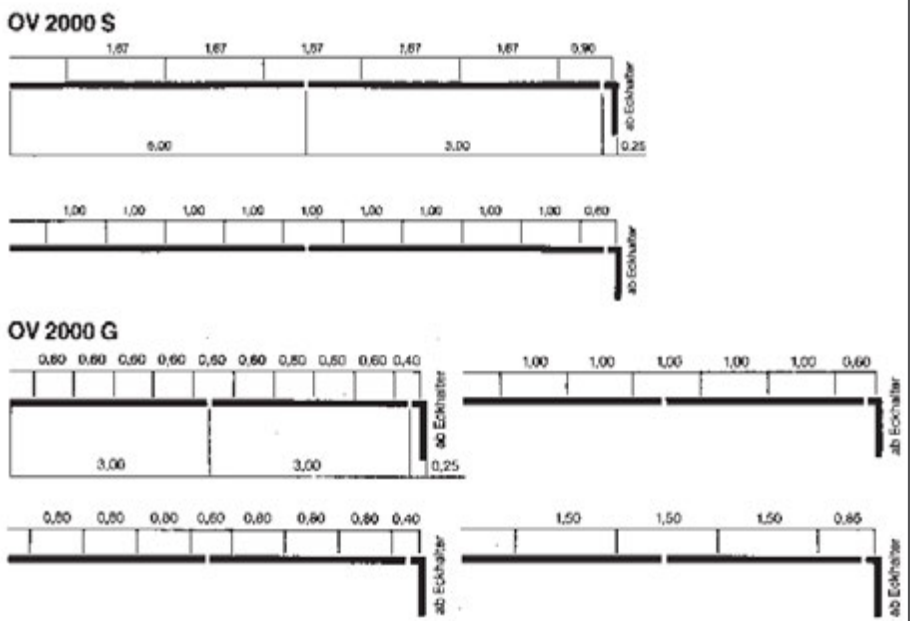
Überstände der Ortgangverkleidungen, sowohl nach oben als auch nach unten über die Fassaden, müssen nach den jeweiligen Bauhöhen und Dachneigungsgruppen gewählt werden (siehe Flachdachrichtlinien). Ab einem Überstand U = 180 mm ist je nach statischer Anforderung eine oder mehrere stirnseitige Befestigungen erforderlich.
